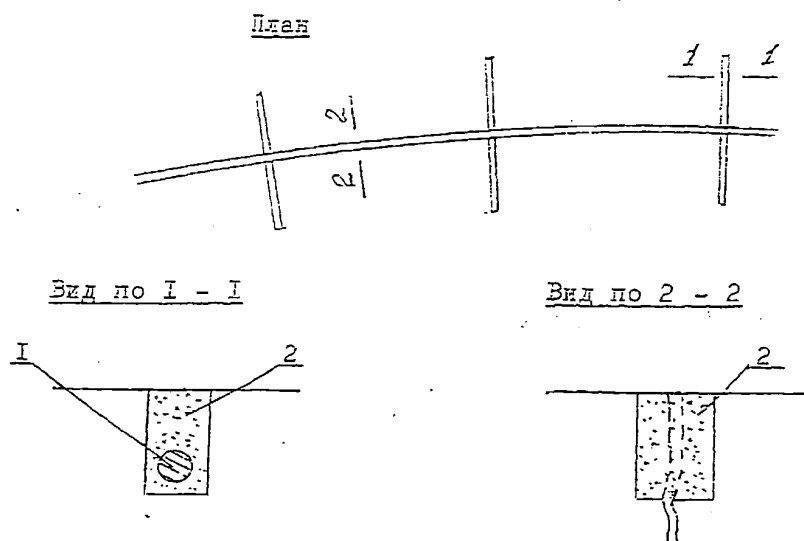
Схема восстановления монолитности бетонных и каменных конструкций. 1 – арматура, 2 – бетон ЭМАКО.
